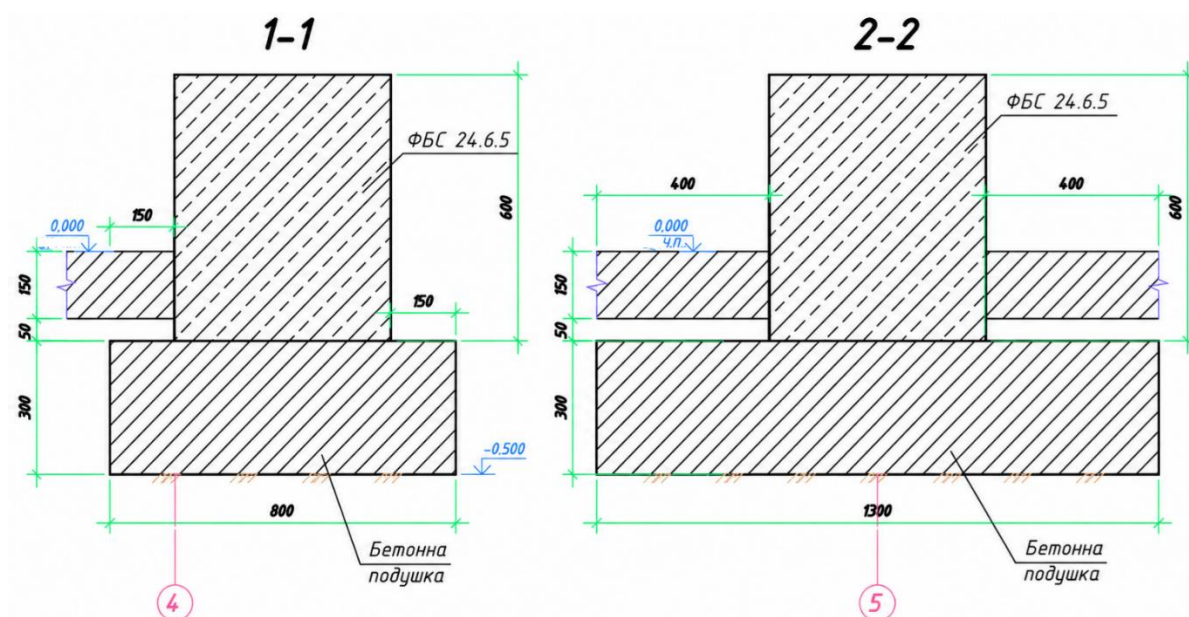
Розрізи 1-1, 2-2 по існуючих фундаментах
